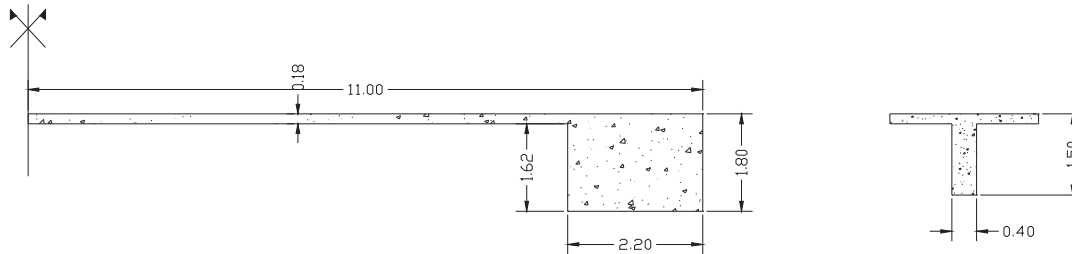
Sección del tablero y vigas transversales (medidas en metros)
